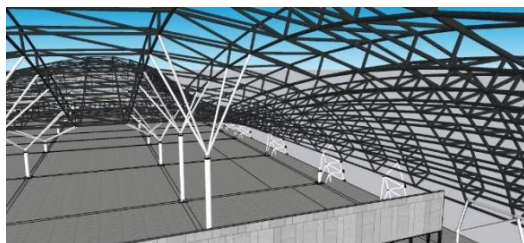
Konsep Konstruksi Beton Bertulang Pada Bangunan RSGM
